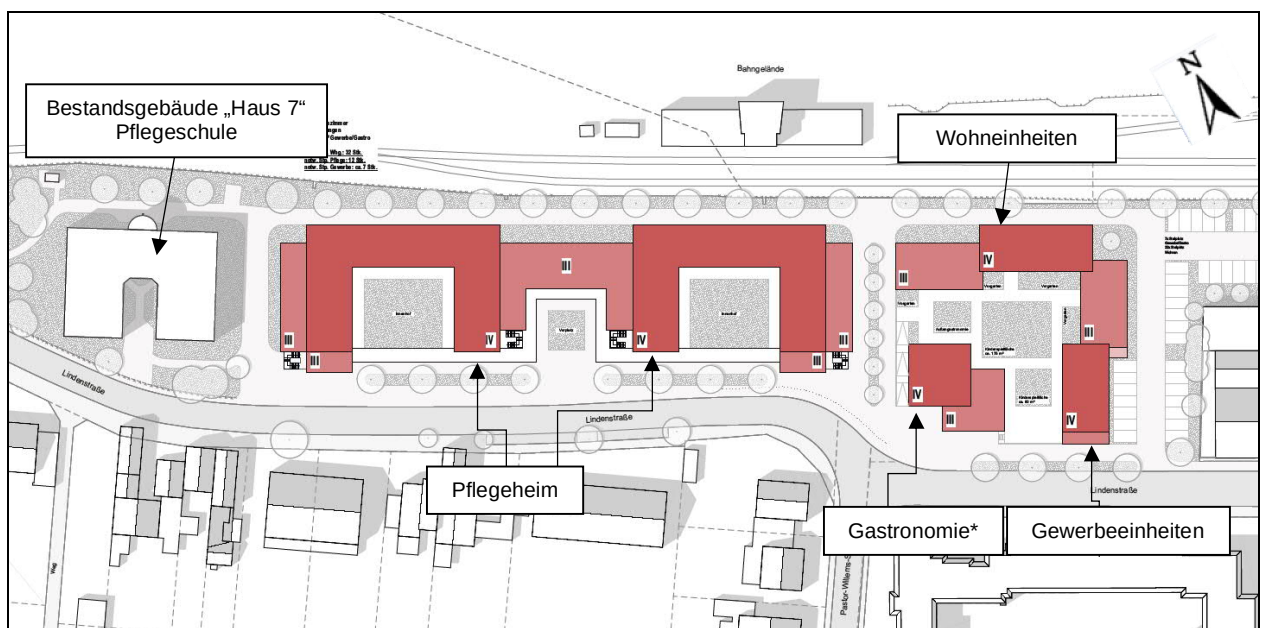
Gebäudeplan der Baukörper (ohne Maßstab, Quelle: /1/)
